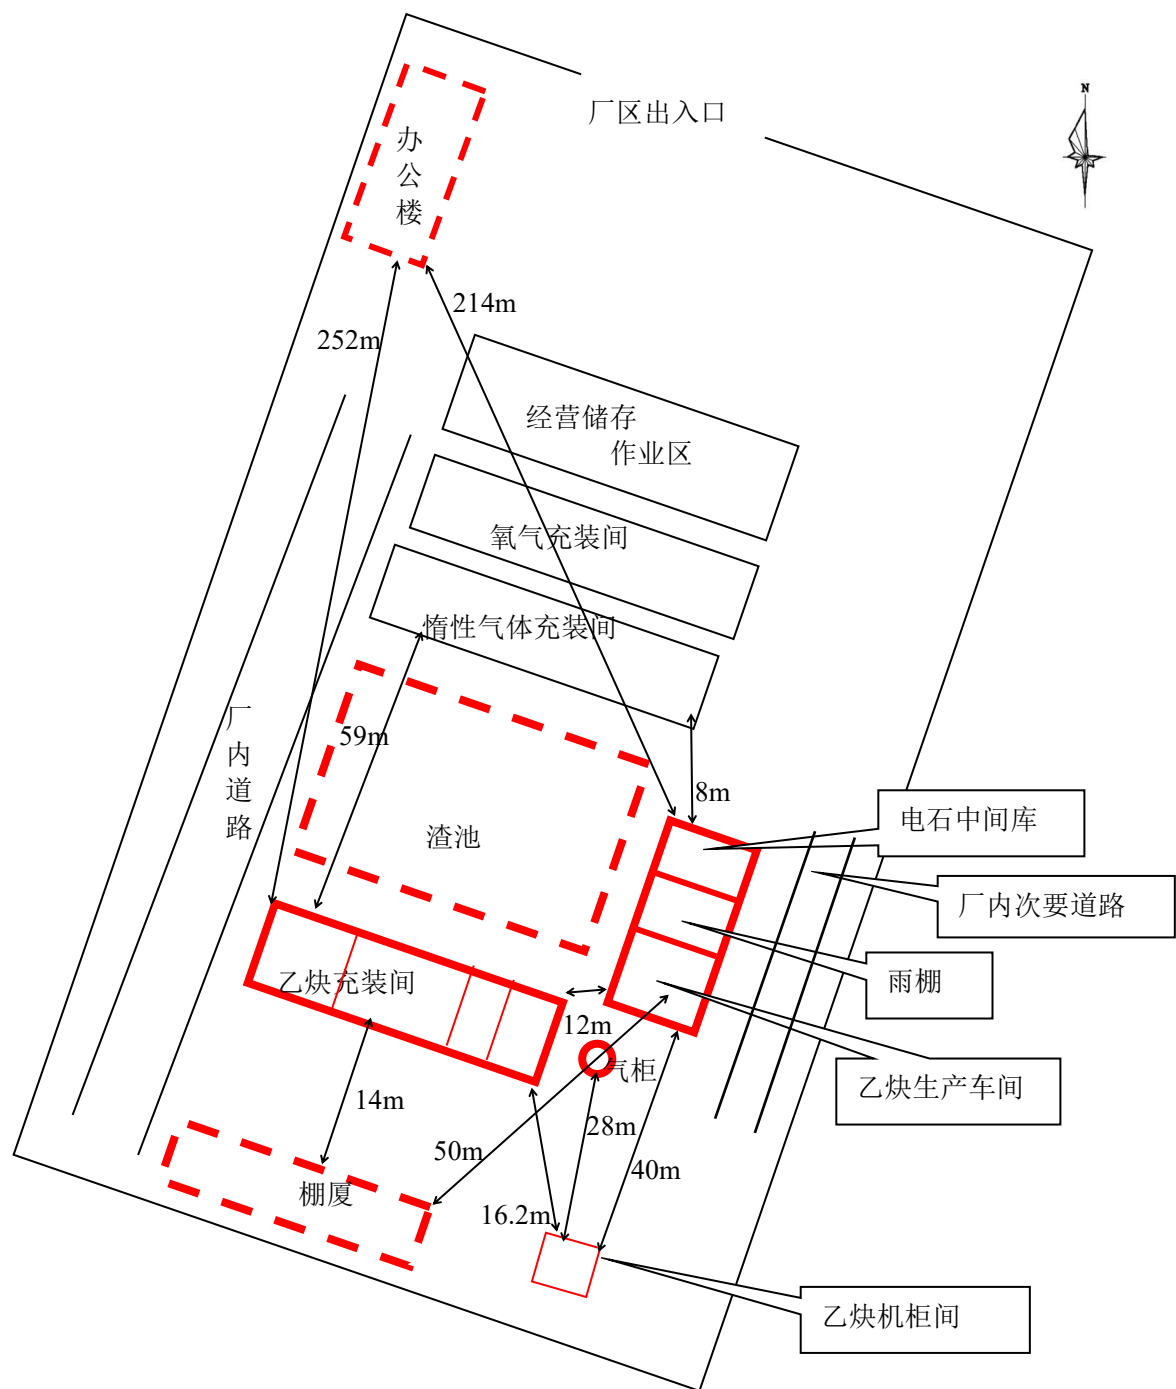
厂区平面布置示意图（红色框区为本次评估范围内建筑）
